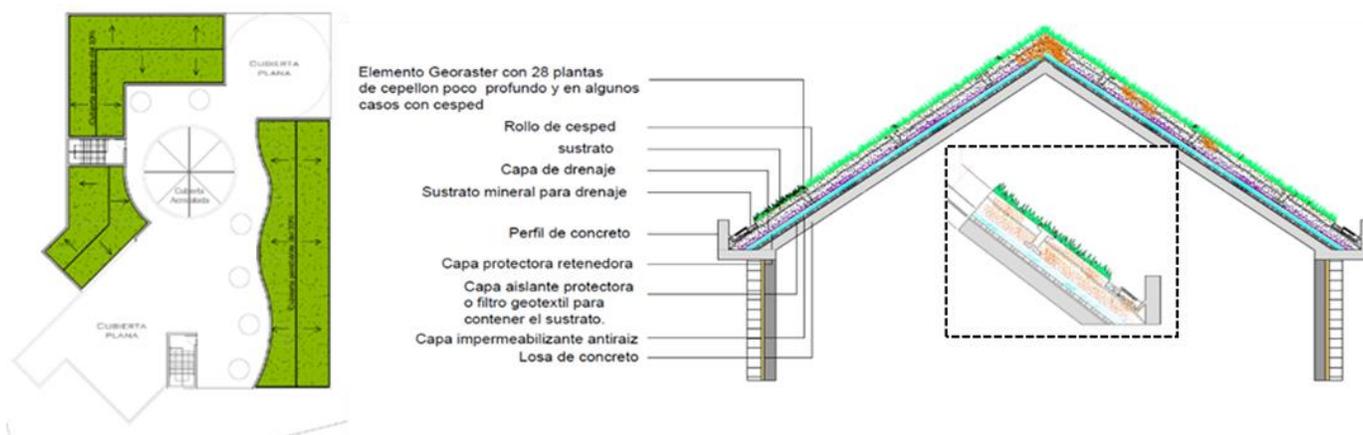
Tipo de Cubierta extensiva y detalle en Corte de la misma.
